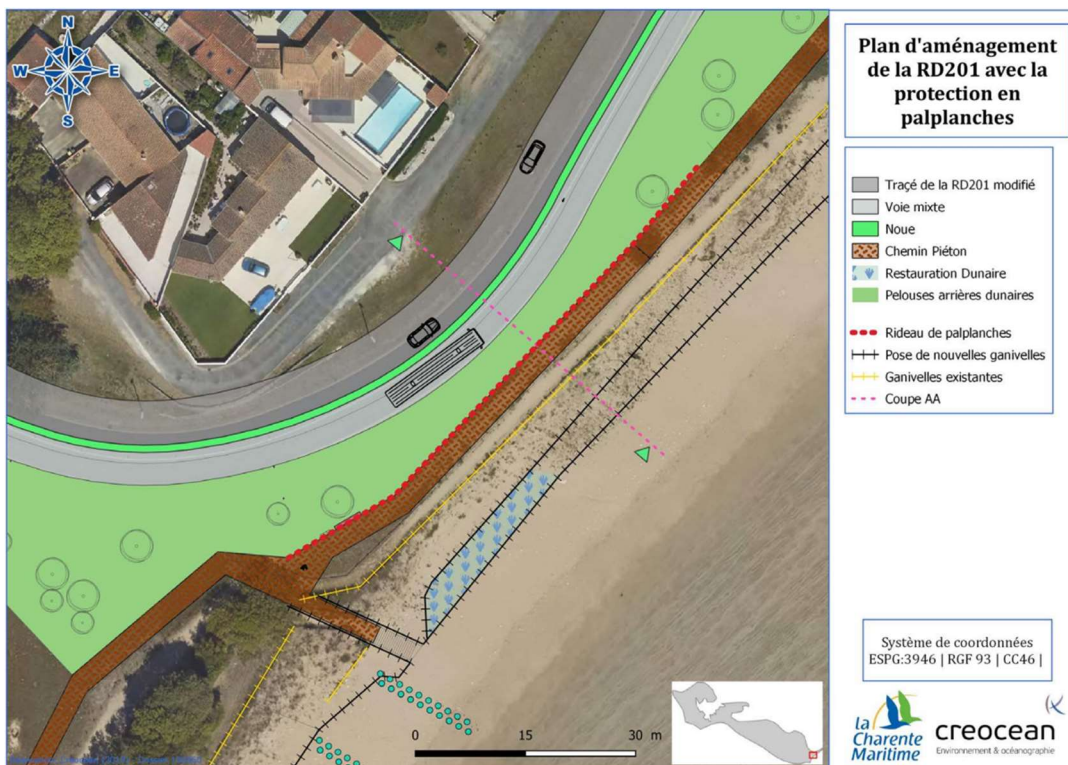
Plans d'aménagement de la RD 201 avec la protection en palplanches
